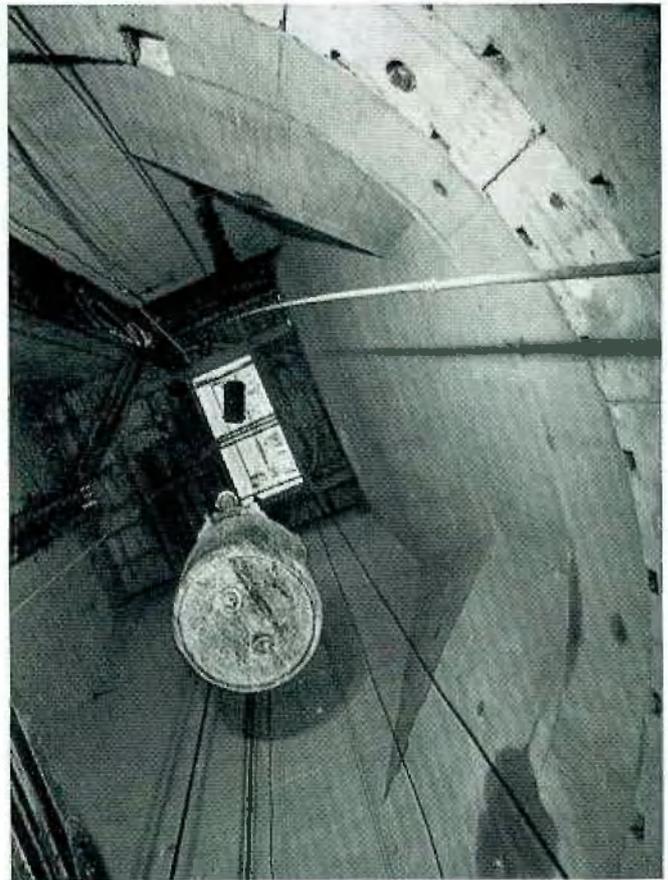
Lüftungsschacht Hospental, obere Schachtmündung mit Übergang vom kreisrunden Profil mit Fertigelementauskleidung auf das Rechteckprofil
